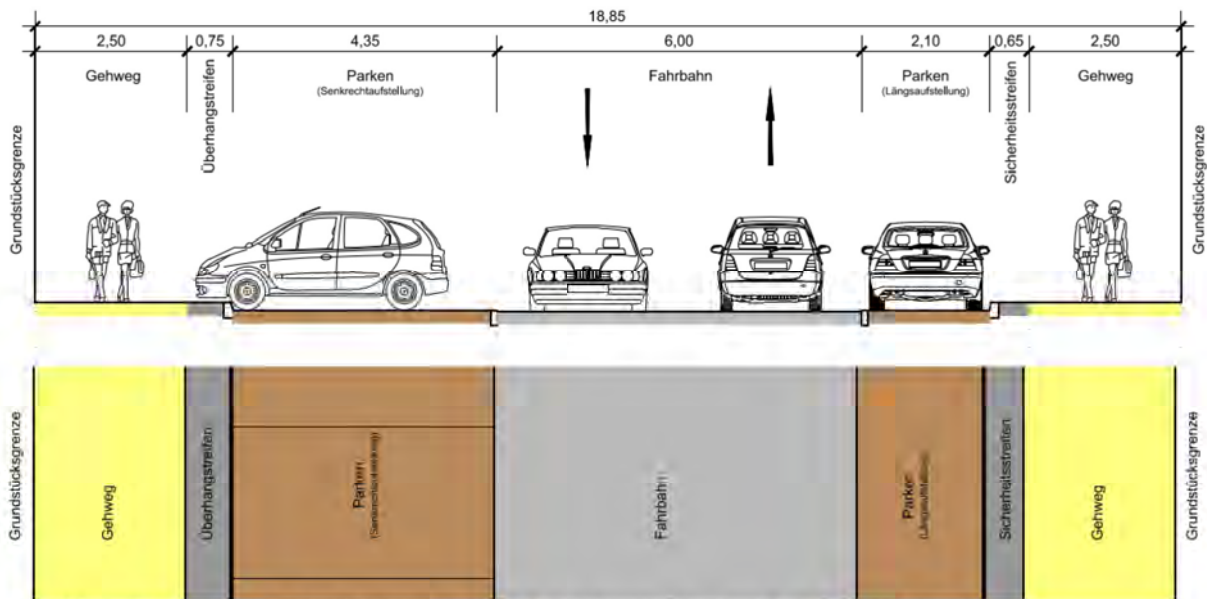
Variante A Planstraße mit Senkrechtparkständen und gegenüberliegenden Längsparkständen
